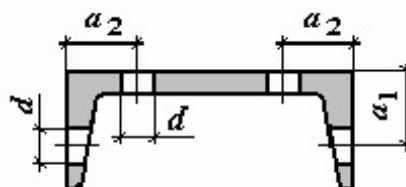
Риски для швеллера по ГОСТ 8240
